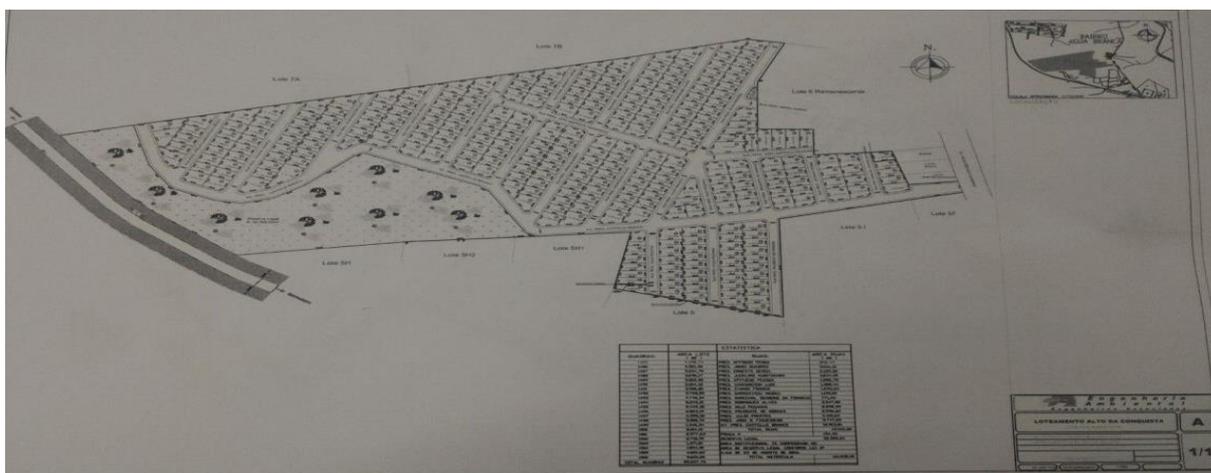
Croqui do loteamento Alto da Conquista, Bairro Água Branca
